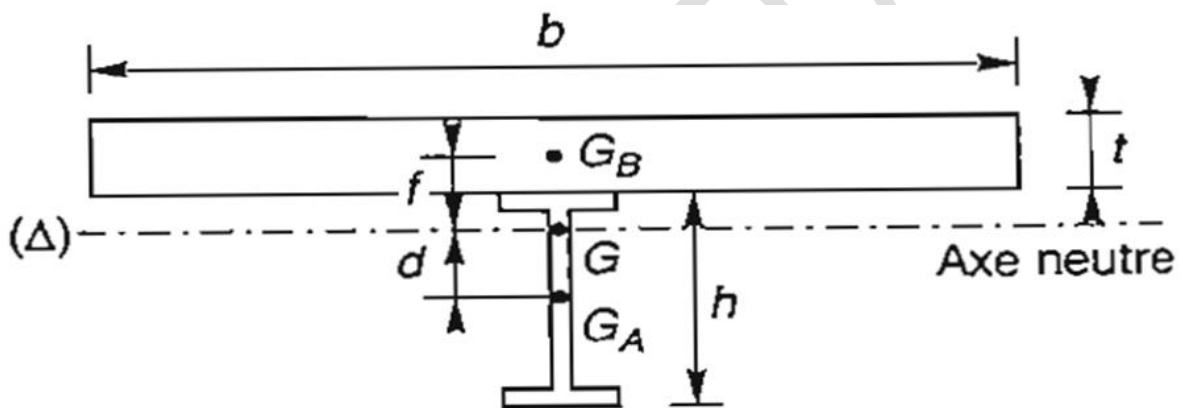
Analyse d'un plancher mixte à dalle collaborante
